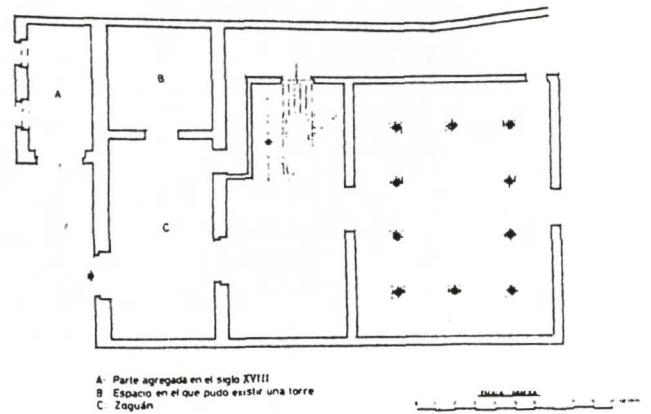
Planta de la Casa de la Rúa, según Juan Uriá.
